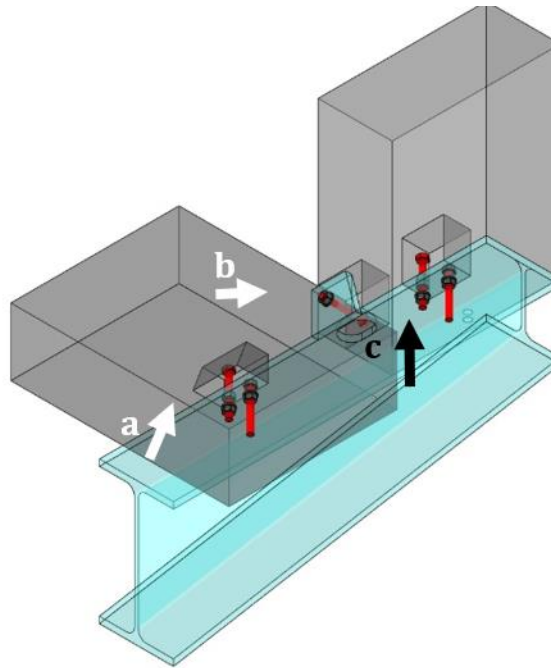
Conexión entre viga y losa en distintas posiciones (inferior en losa (a), lateral (b) y fondo de viga (c)).
